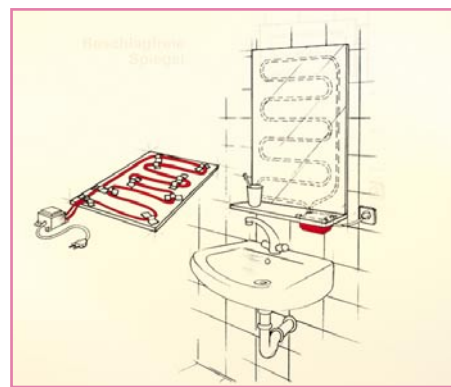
Beschlagfreie Spiegel – Montageprinzip
